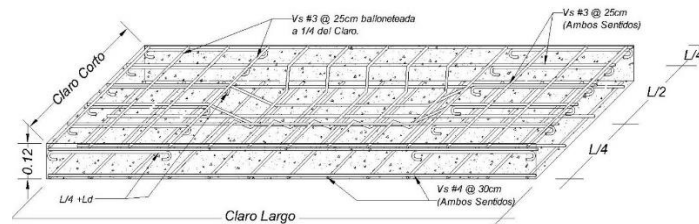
Detalle de placa de entrepiso de Príncipe Pio
